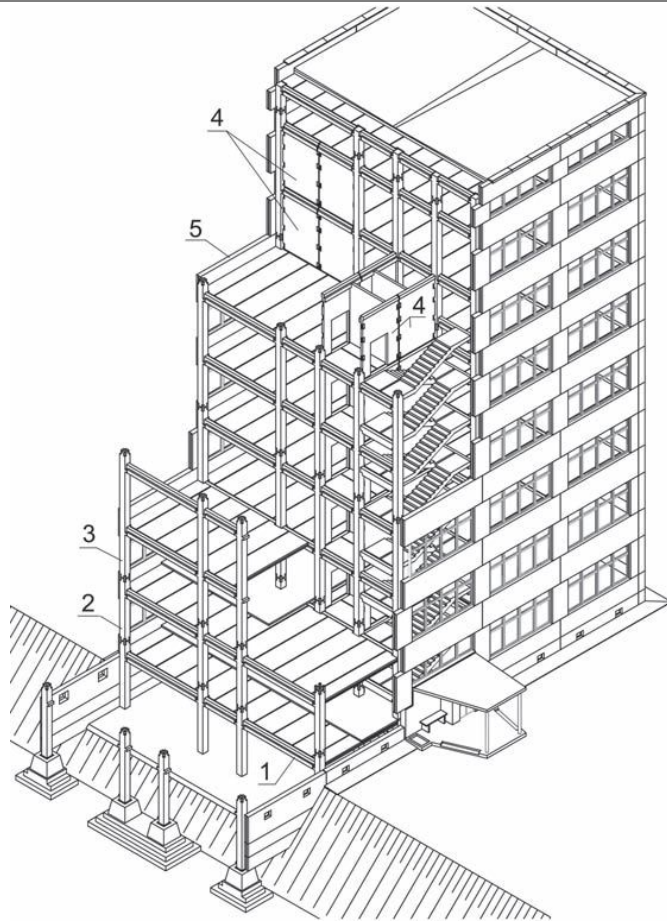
Многоэтажное здание рамно-связевой конструктивной схемы: 1 - железобетонный ригель; 2 — железобетонные колонны высотой на этаж; 3 - железобетонные колонны высотой на два этажа; 4 — диафрагмы жесткости в плоскости поперечных и продольных рам; 5 — панели ограждения
